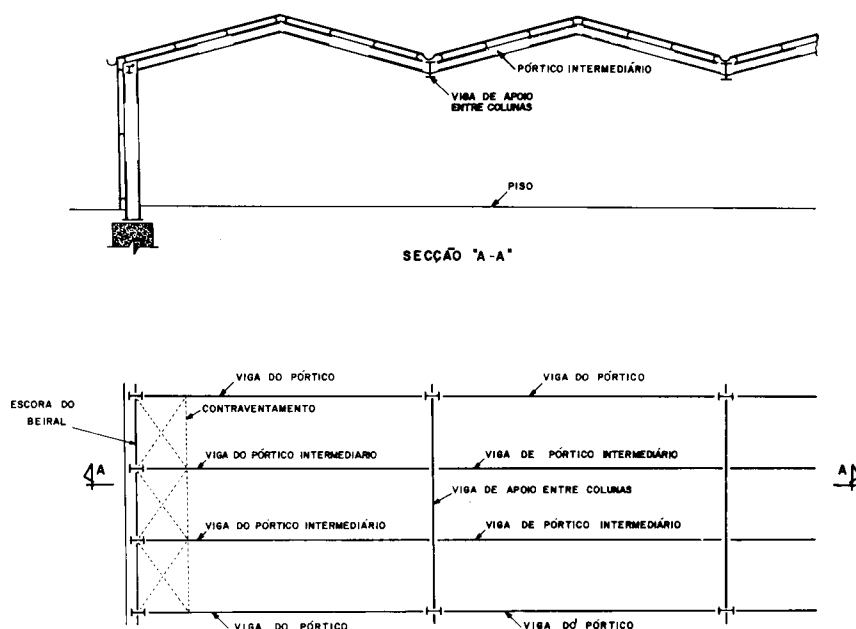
Vigas de semipórtico apoiadas em vigas retas
